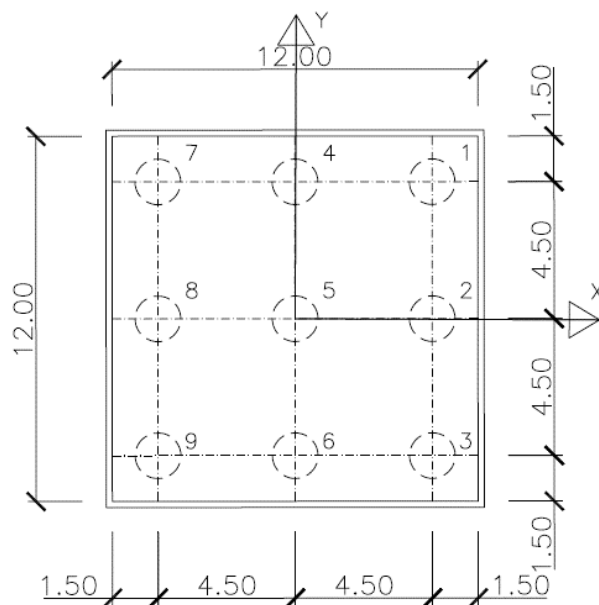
pianta pali – Pile 10 ÷ 14 a 9 pali
